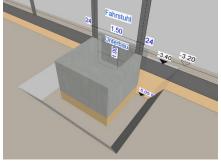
Mehrere Baugruben (Baugrube Unterbau Fahrstuhl)
